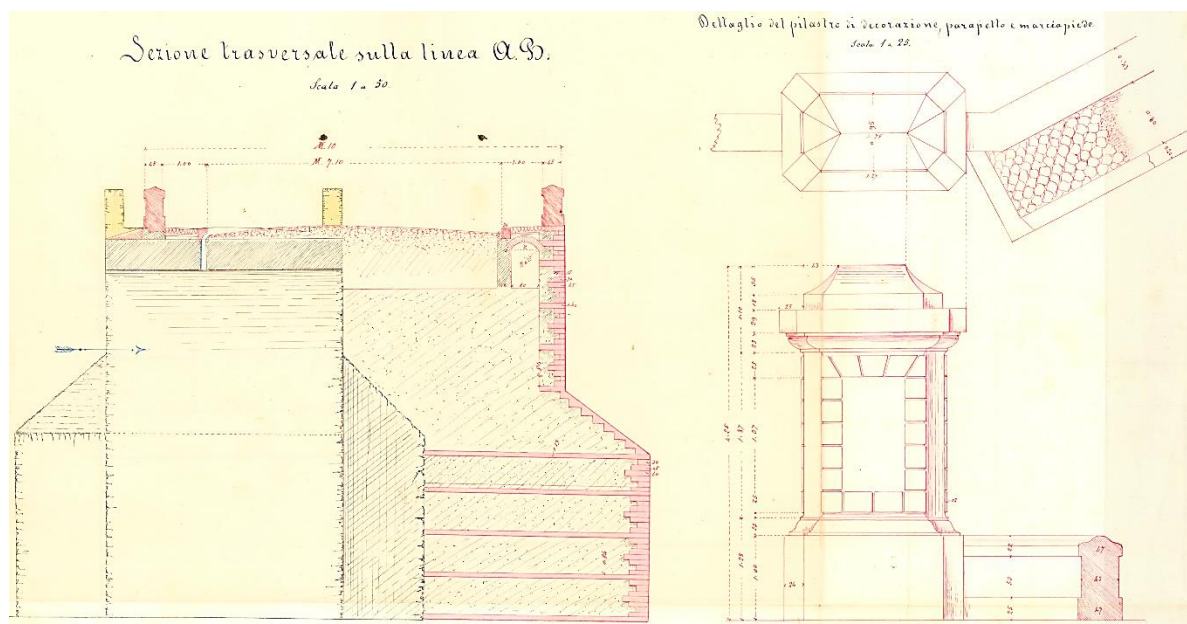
Sezione trasversale del Pontelungo in riferimento alla soluzione con allungamento delle pile e spalle (a sinistra); dettagli del pilastro di decorazione, del parapetto e del marciapiede. [169]
